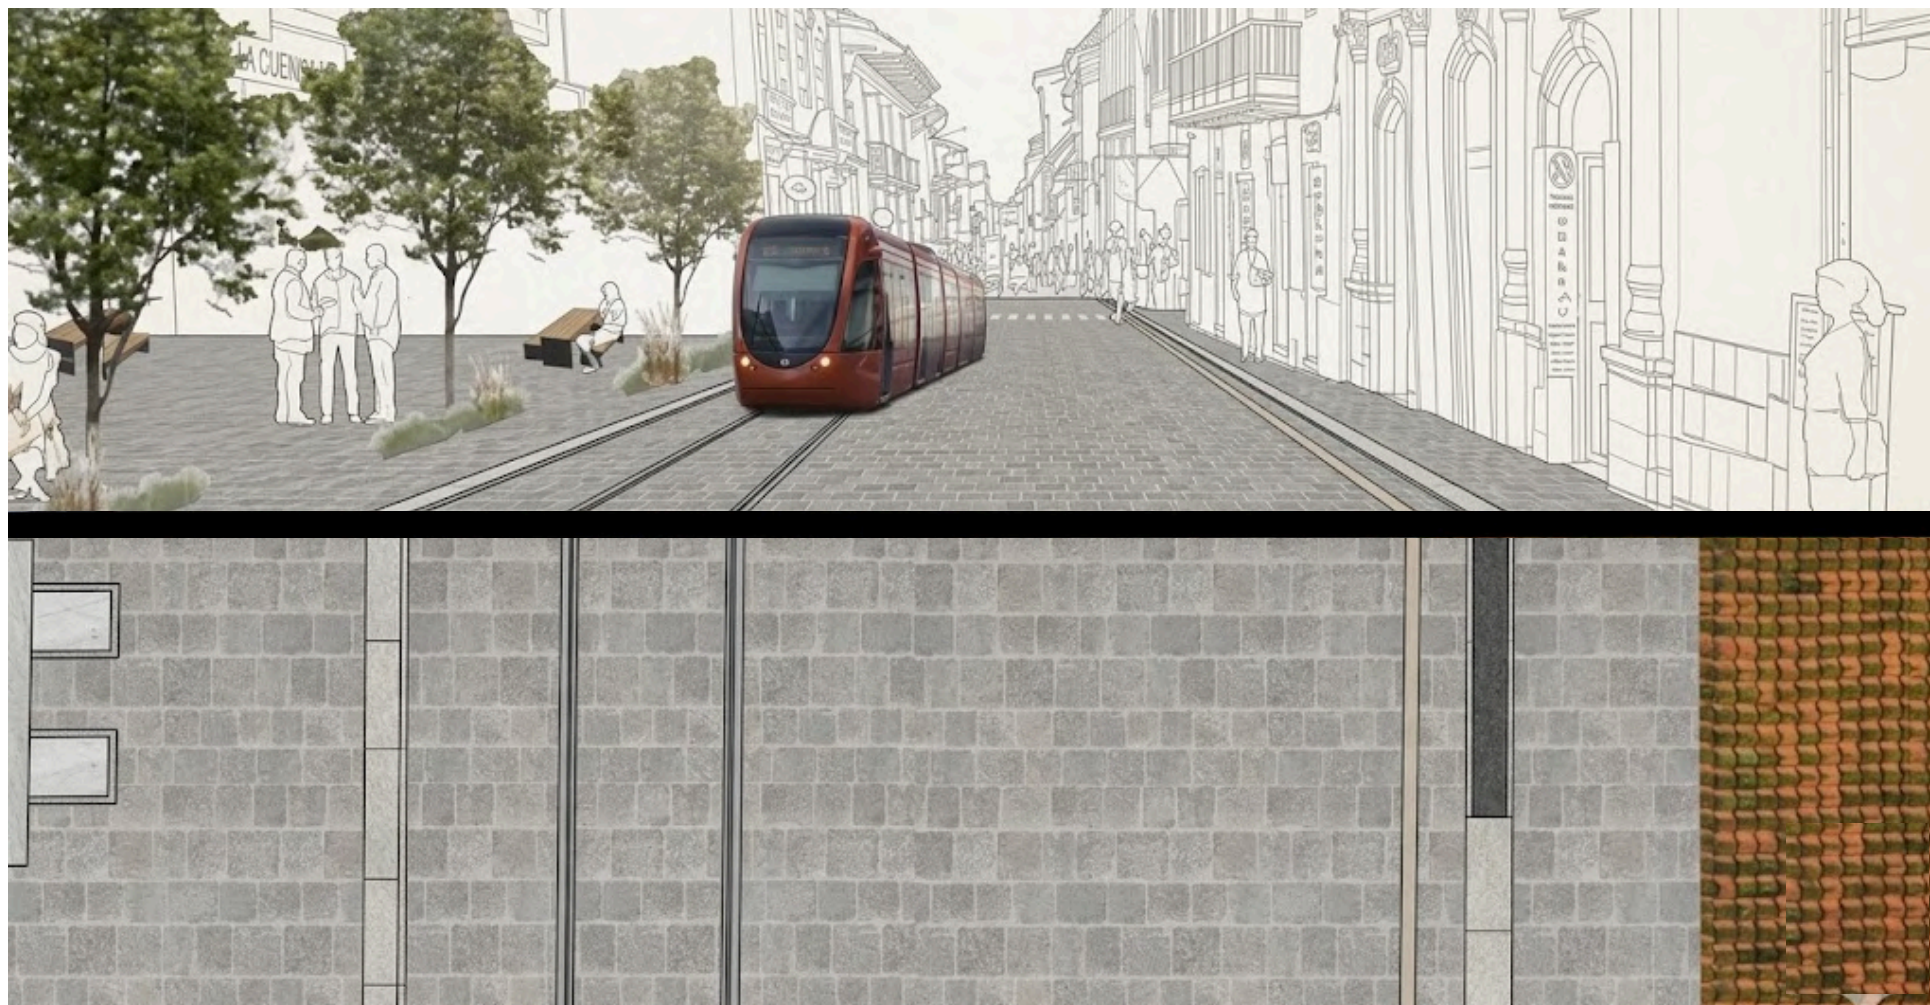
(sección vial intervención Mariscal Lamar zona este) 2025, Autoría propia.
